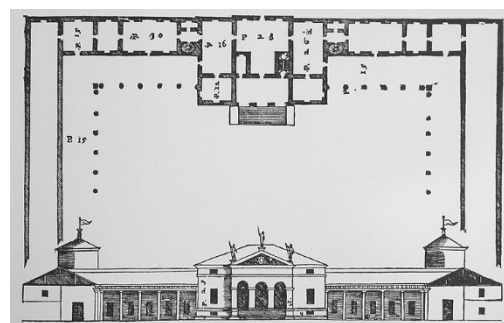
Le plan de Palladio de la Villa Saraceno (Palladio, 2002).
